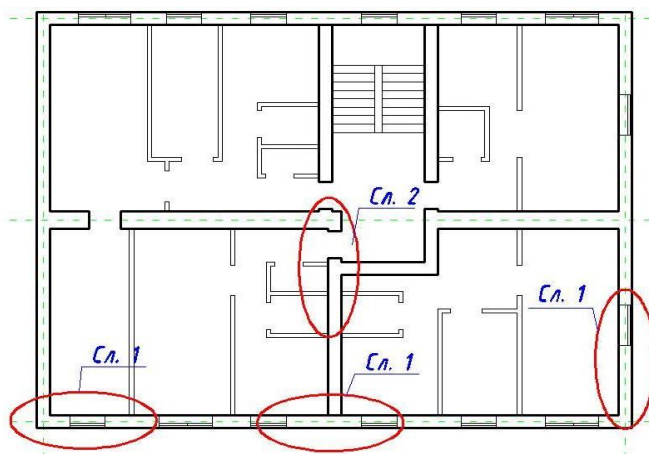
Схема расположения локальных разрушений типового этажа кирпичного здания
